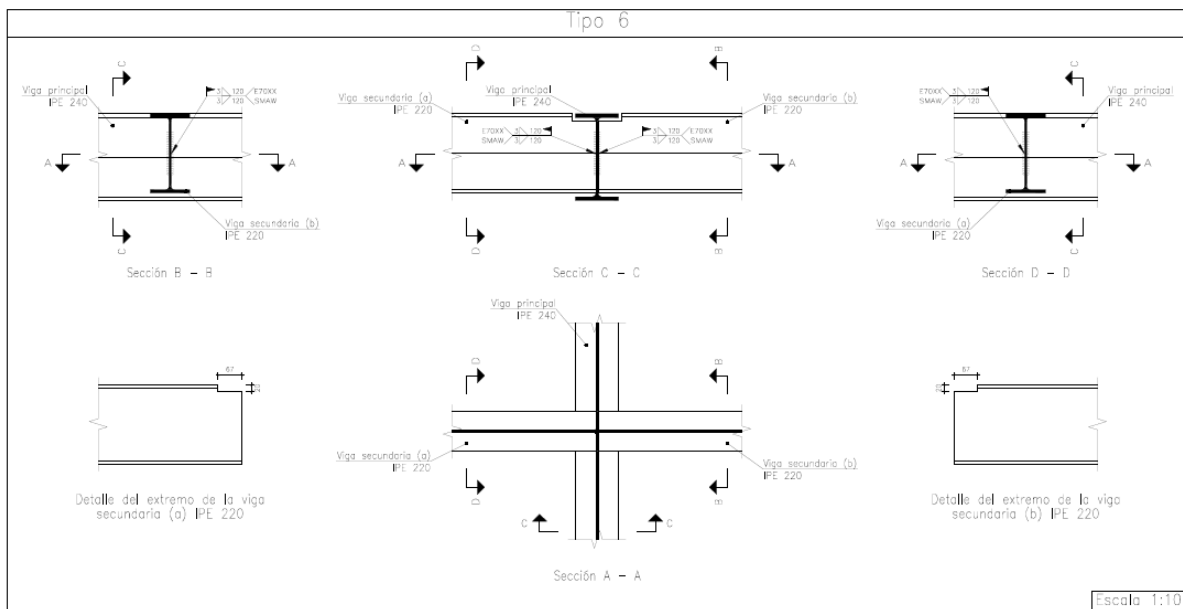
Plano Detalles Uniones. Colegio. CAJAMAG.
